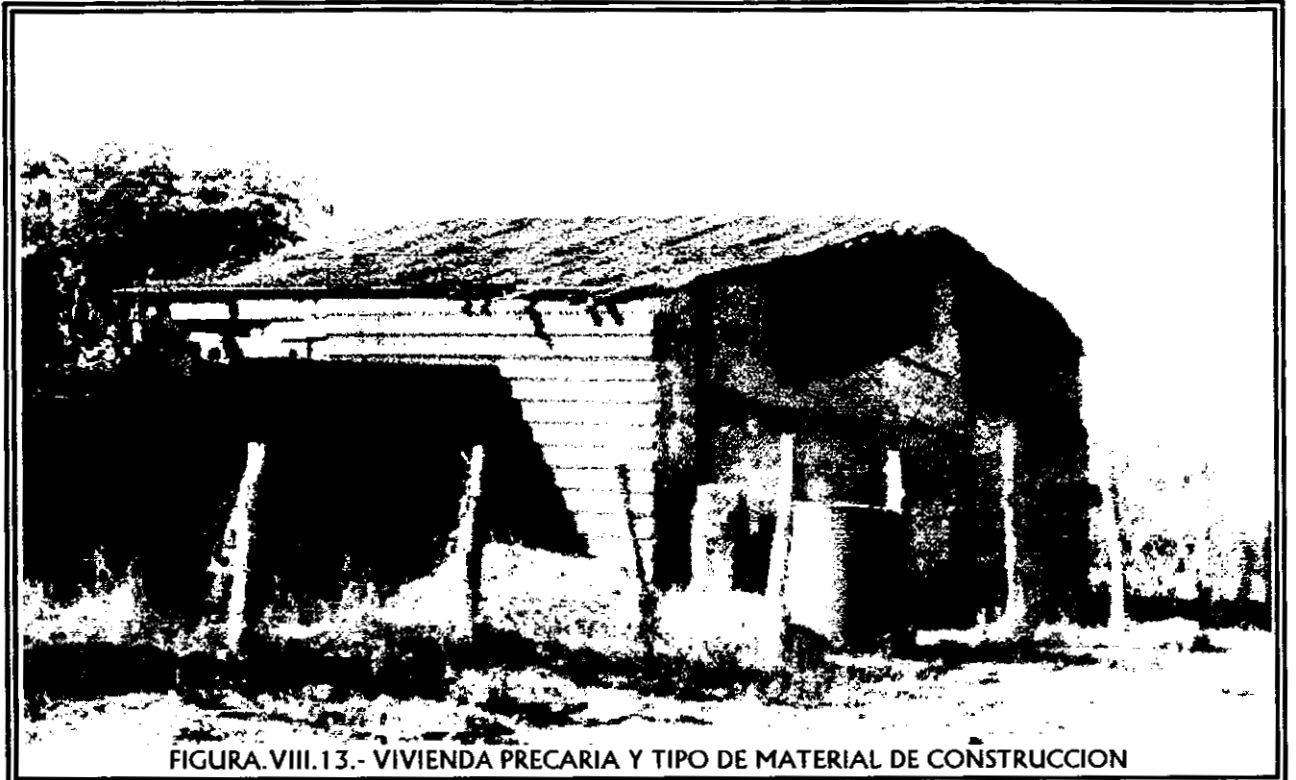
VIVIENDA PRECARIA Y TIPO DE MATERIAL DE CONSTRUCCION
